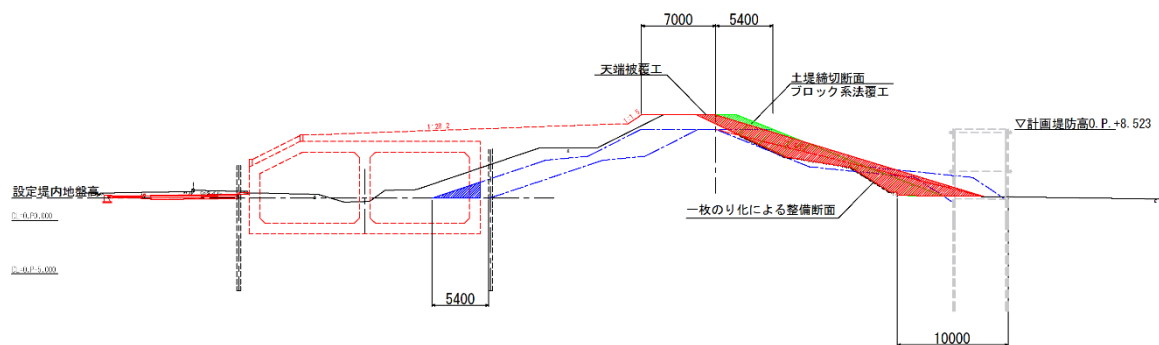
標準断面図 (施工タイプ B) (次項へ続く)
